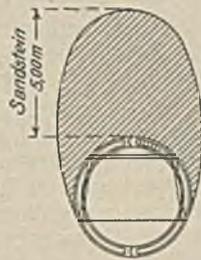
Die vom Eisenbetonausbau getragene Höchstlast.
